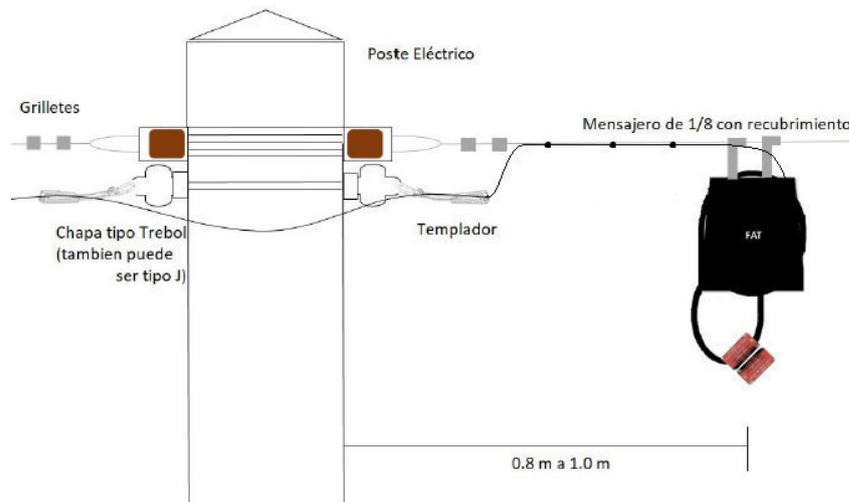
Instalación de cable preconectorizado en poste. Fuente: Elaboración propia
